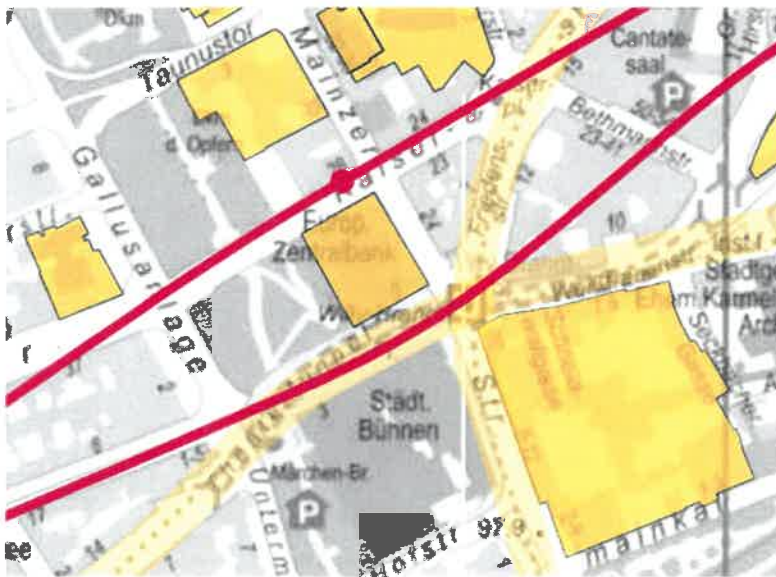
Ausschnitt aus Lageplan Variante S2-W-T2-2-MK-NM
